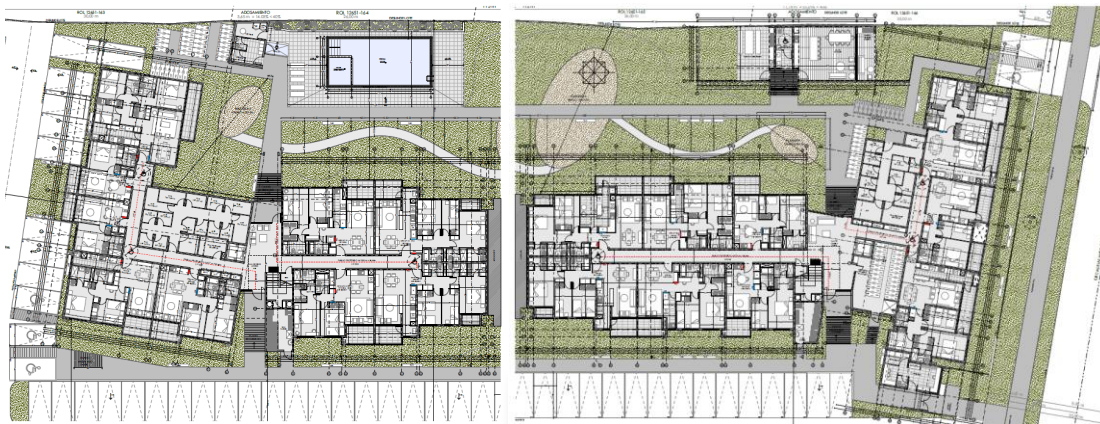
Planta Arquitectura Nivel 1, Bloque Sur y Bloque Norte. Fuente: Planos de Arquitectura Edificio Espacio Huertos, Aitue S.A.
